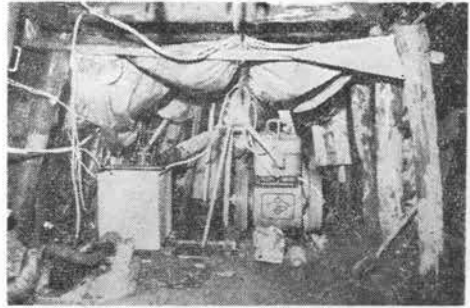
東口底設導坑ウエルポイント・ポンプ設置状況
